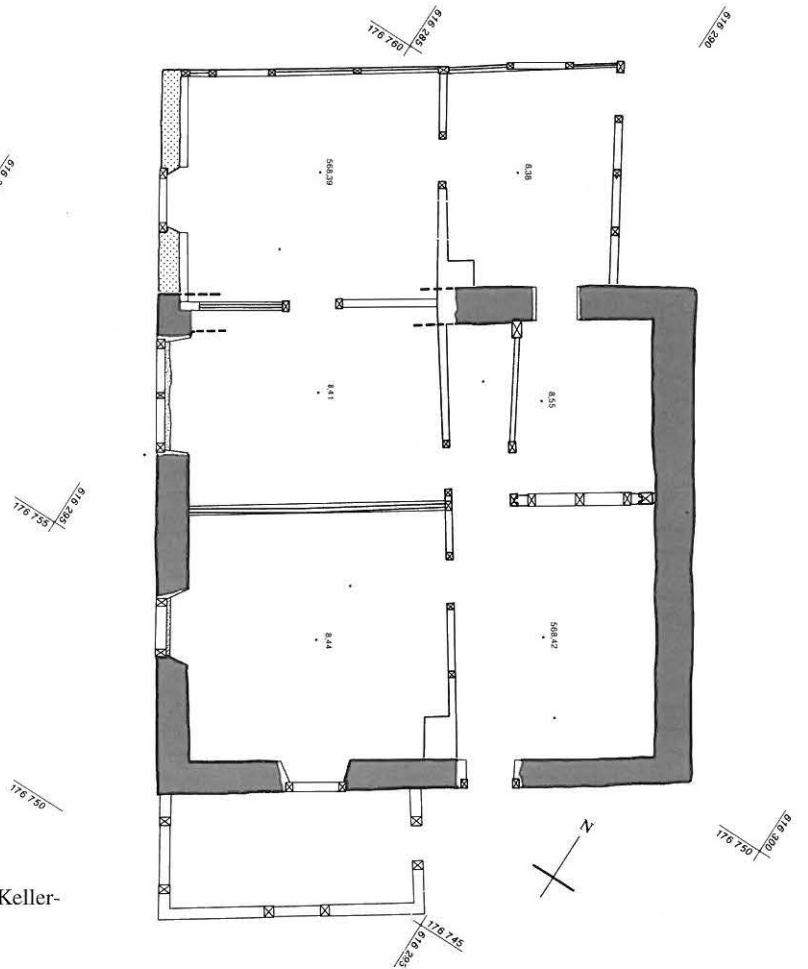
Grundriss des 1. Obergeschosses. M. 1:150.
